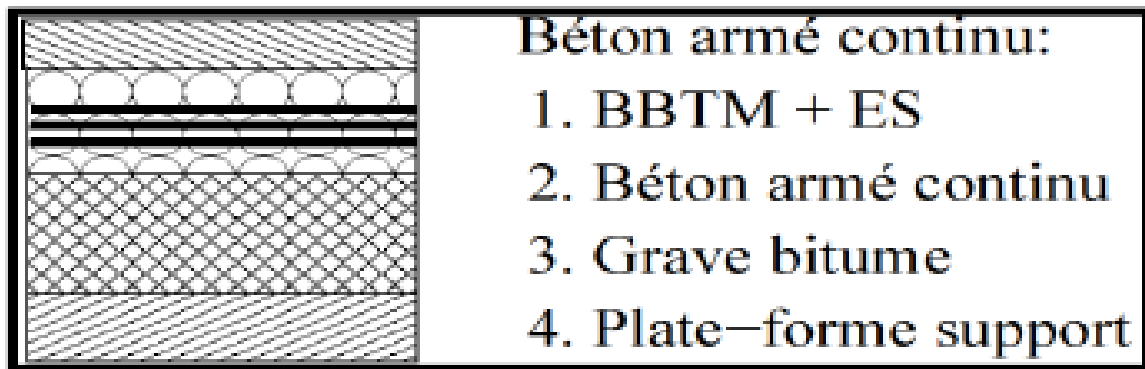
Béton armé continu sur Grave bitume (BAC/GB)
